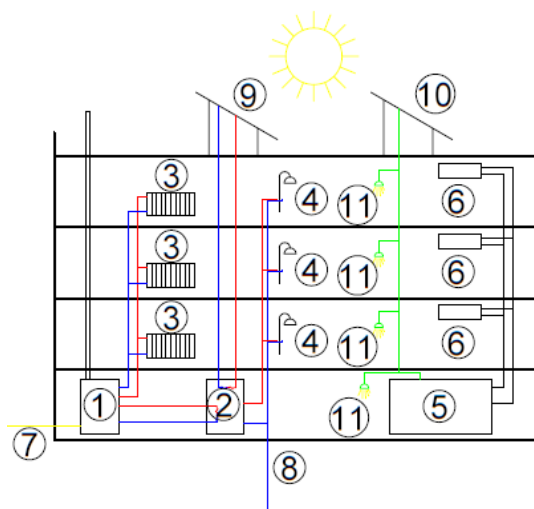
2. Varianta – Plynový kotel, centrální vzduchotechnická jednotka a solární panely
